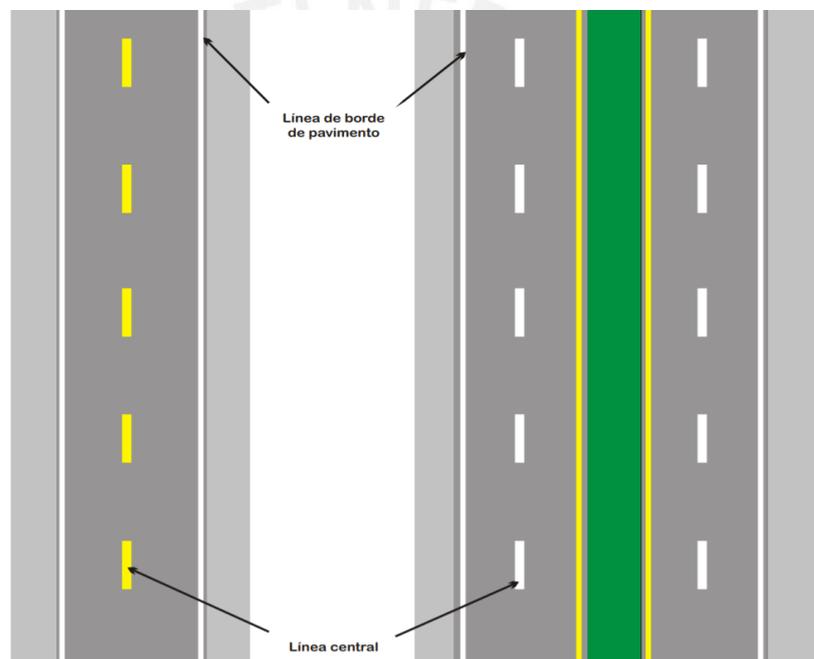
Líneas centrales y de borde de pavimento. Fuente: Manual MTC.
